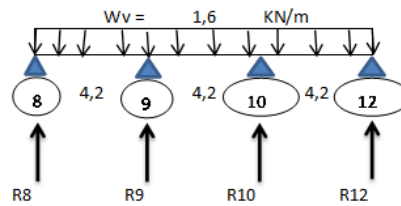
Modelo matemático de viguetas tipo 1, carga viva actuante
